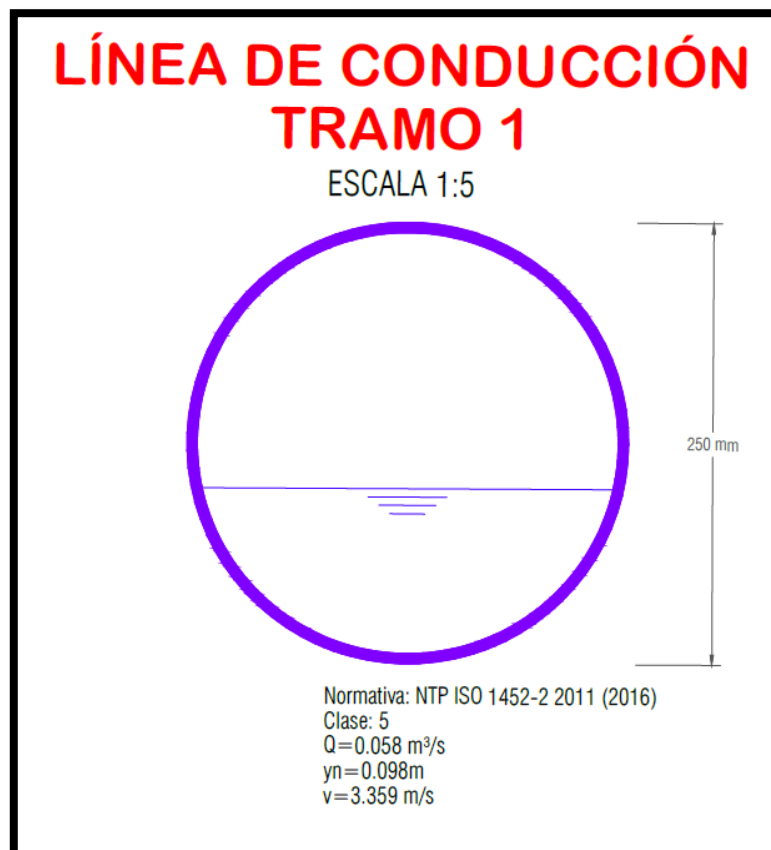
Sección típica de la tubería de PVC-U 250 mm, Tramo 1
